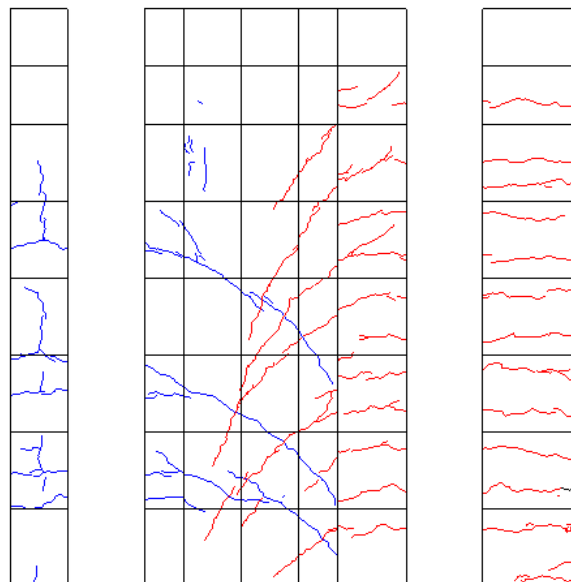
R=1/200②ひび割れ図
